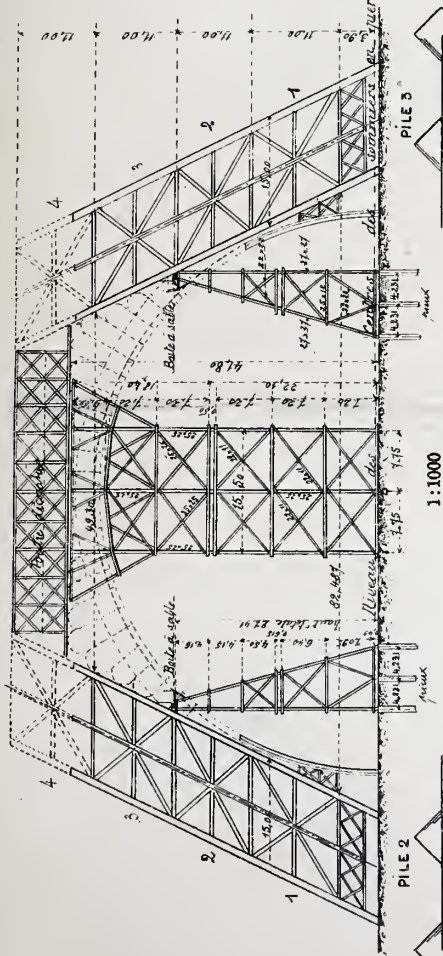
Elévation suivant A. B. (Plan Fig. 2)
